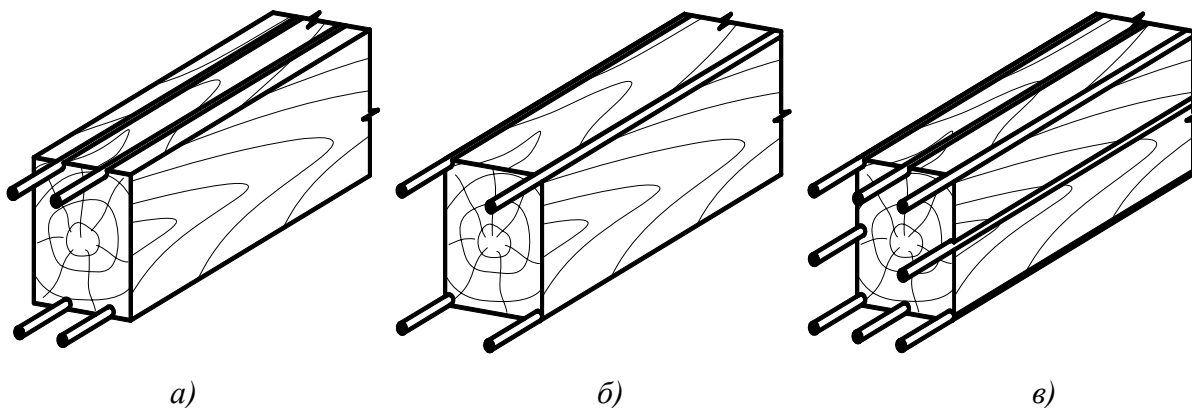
Армированные элементы из цельной древесины: а – армирование части сечения; б – армирование по углам сечения; в – армирование по всему сечению
